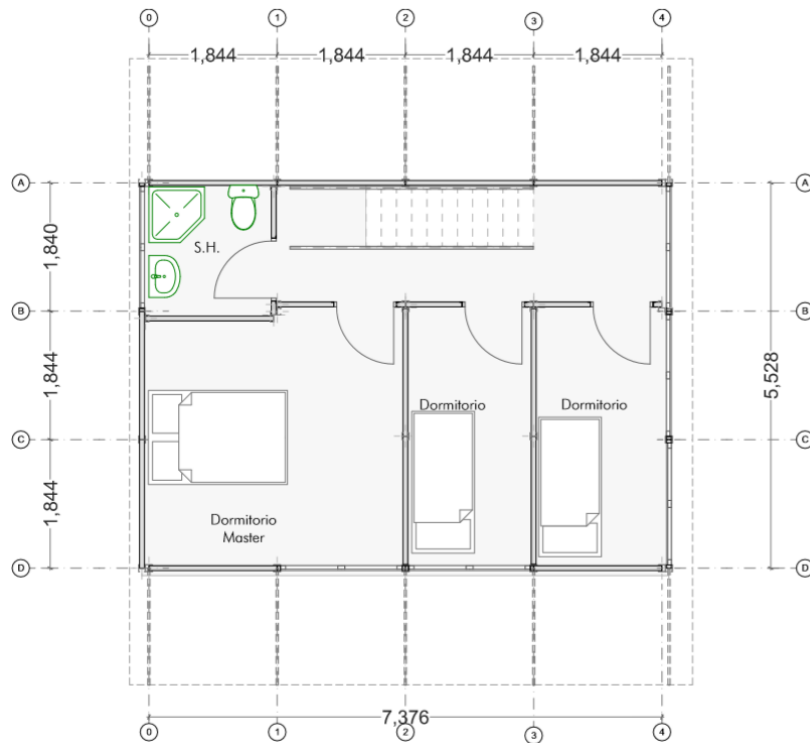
Plano arquitectónico de la planta alta de la vivienda de 2 plantas (Opción B)
